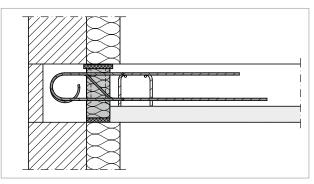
Schöck Rutherma® T type DF : liaison pour façade en maçonnerie et plancher constitué de prédalles
